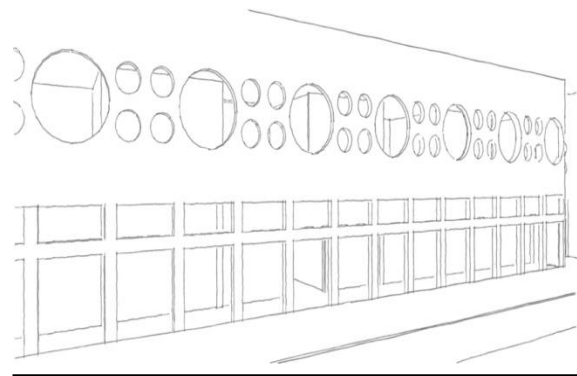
croquis de la Façade intérieur de l'équipement Source : auteur 2018
